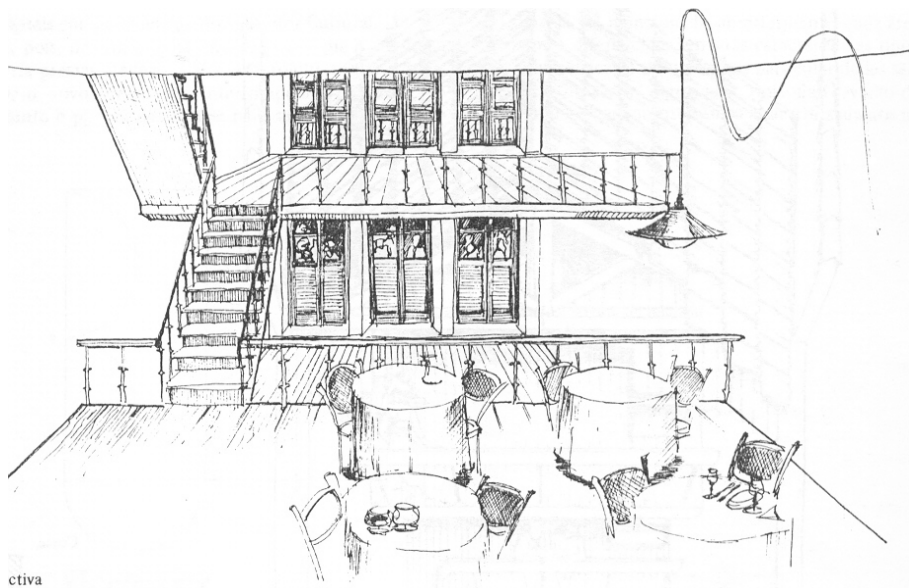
Perspectiva de uma sugestão para obra de modificação com acréscimo de pavimento mantendo o uso das janelas (INSTITUTO, 1985, p. 45)
